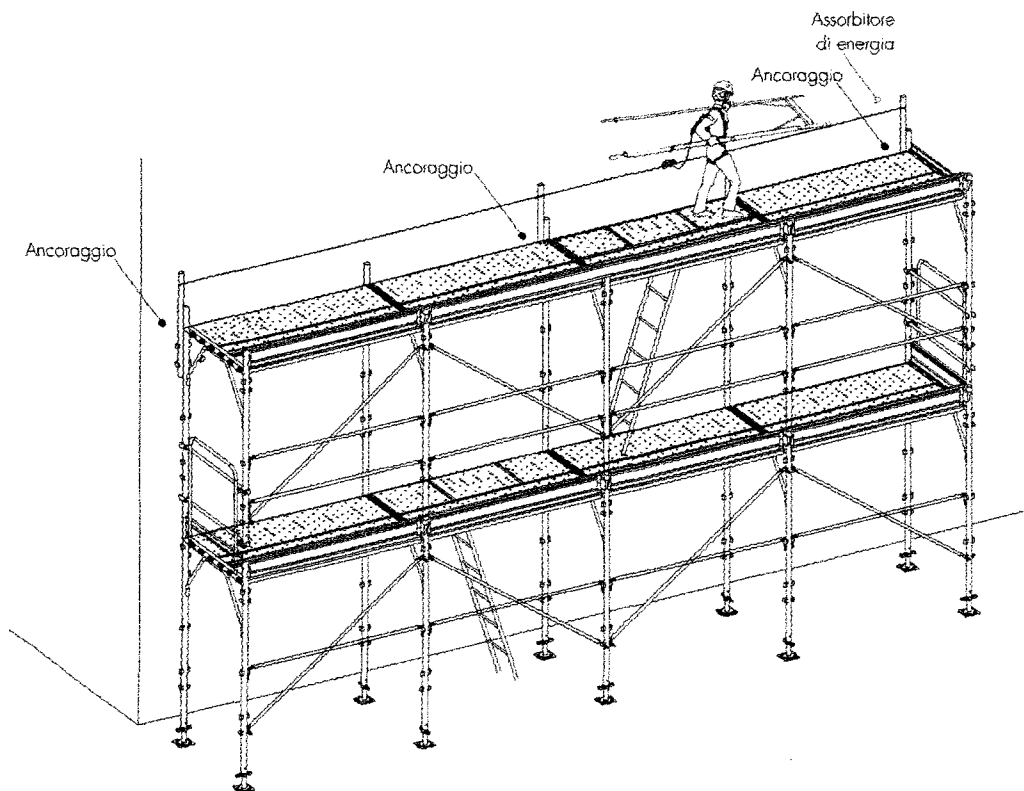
Fase operativa di montaggio del terzo livello: linea di ancoraggio posta ad un livello più elevato rispetto al piano di lavoro
